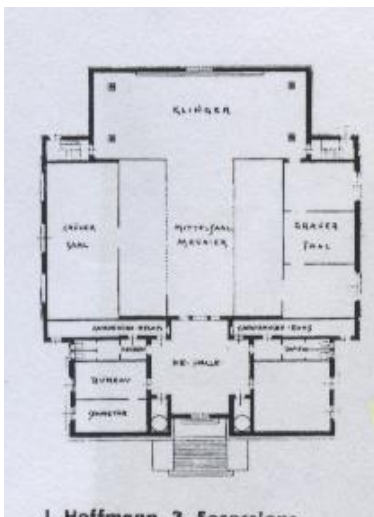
Hoffmann: Grundriss, 3. Secessionsausstellung, 1899
